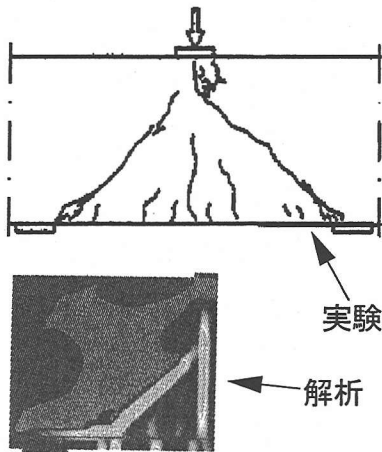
ひび割れ発生状況 (h=600mm)
